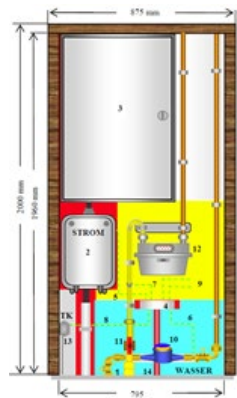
Ausführungsbeispiel einer Hausanschlusswand
